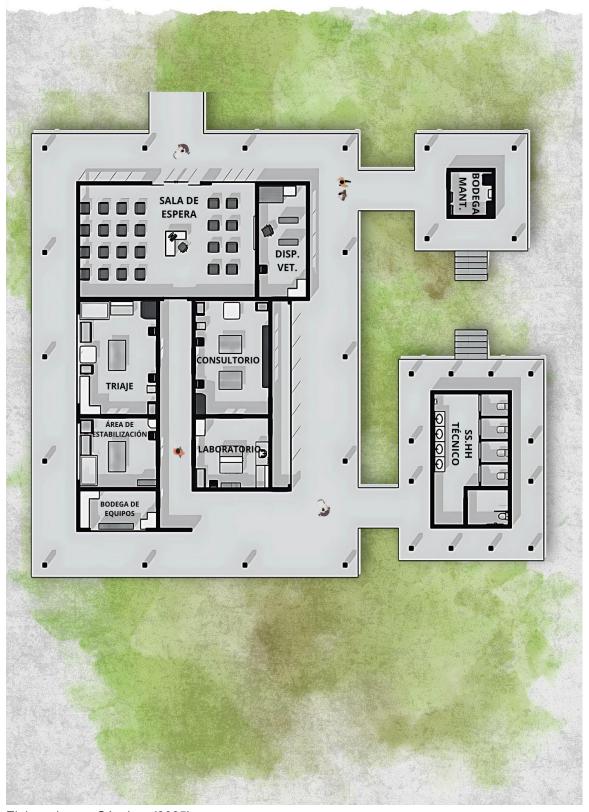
Planta arquitectónica, módulo de fauna silvestre
